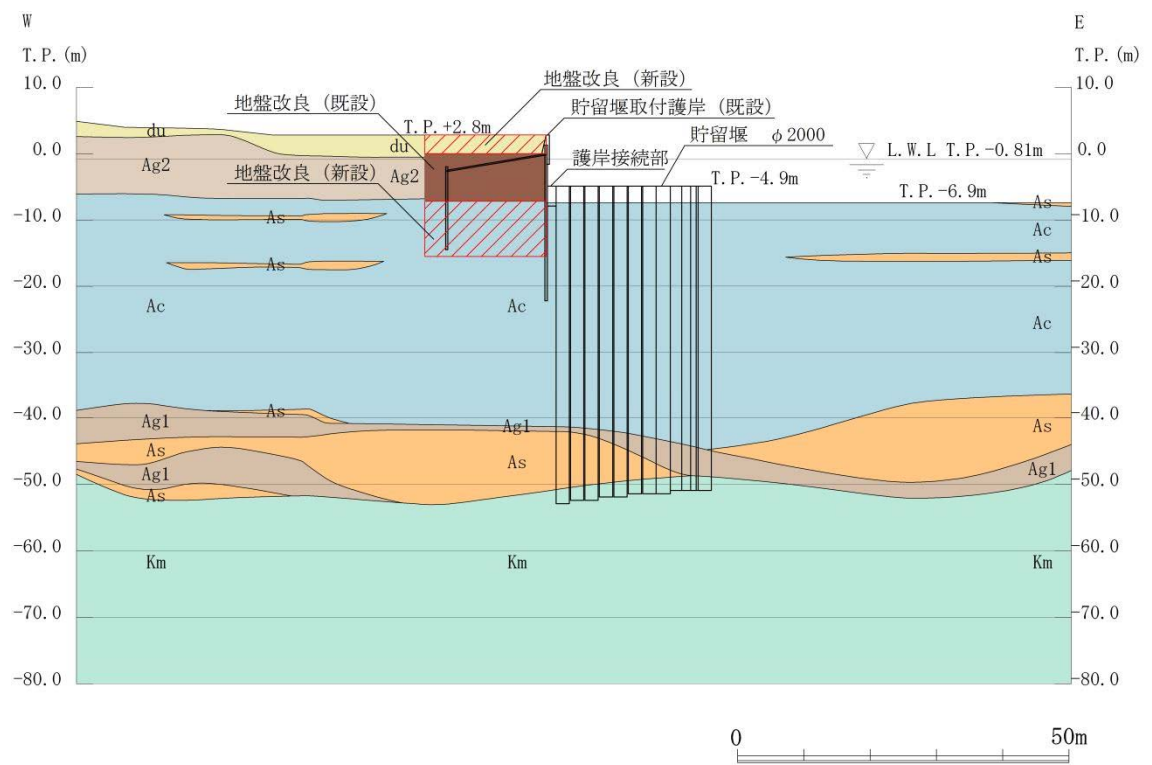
(1) 貯留堰の断面図 (EW-1)
